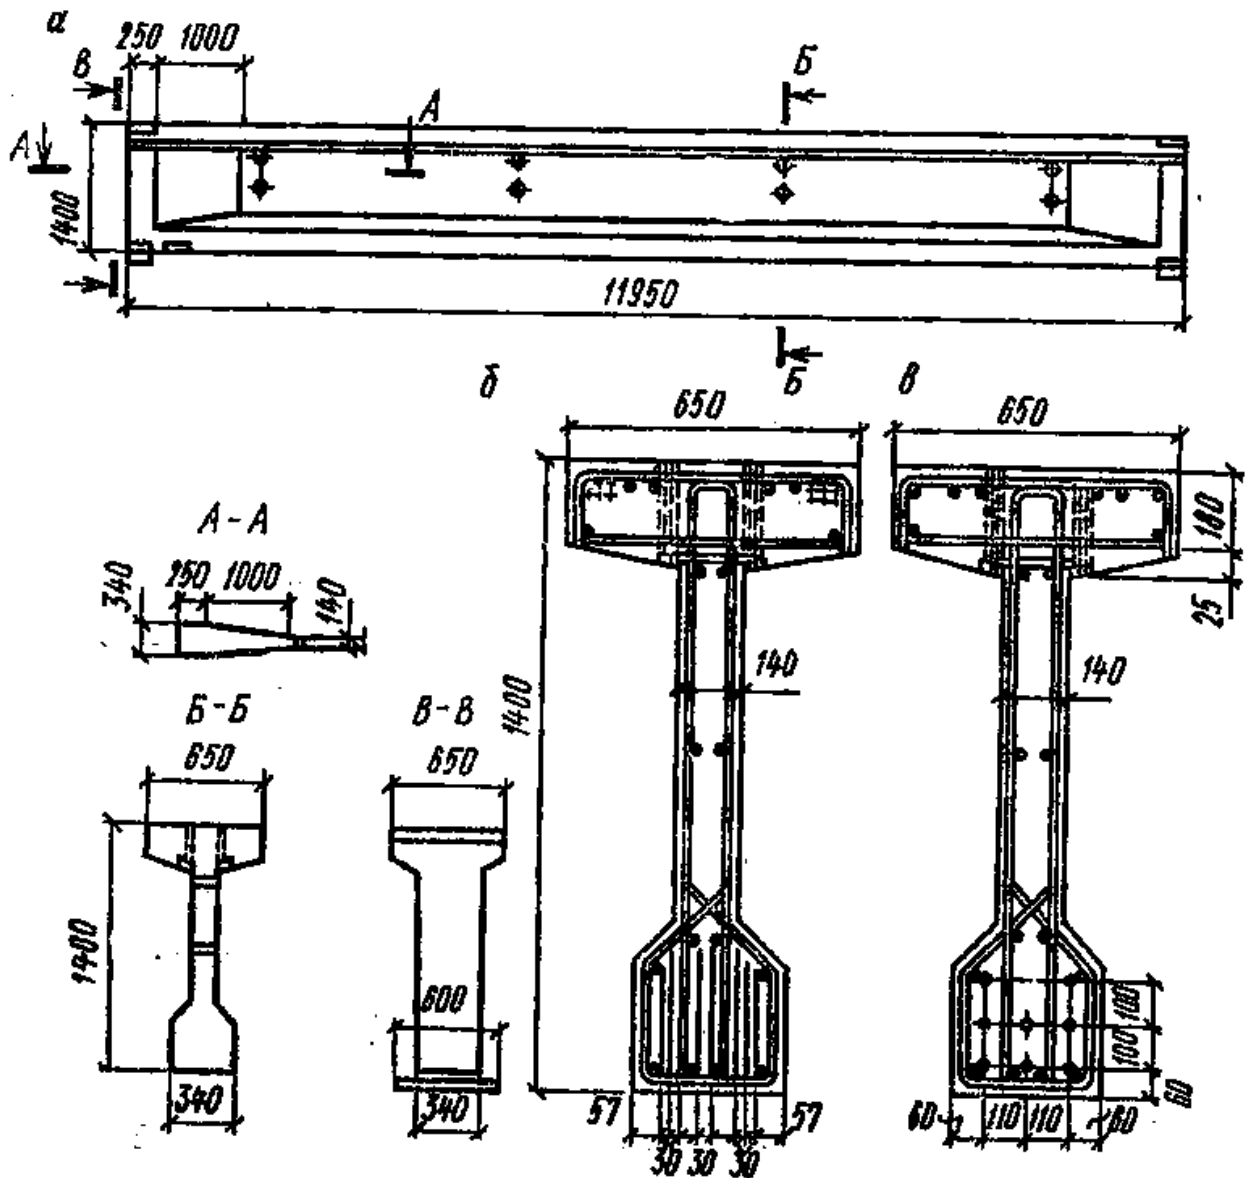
Конструкция предварительно напряженной подкрановой балки пролетом 12 м:
